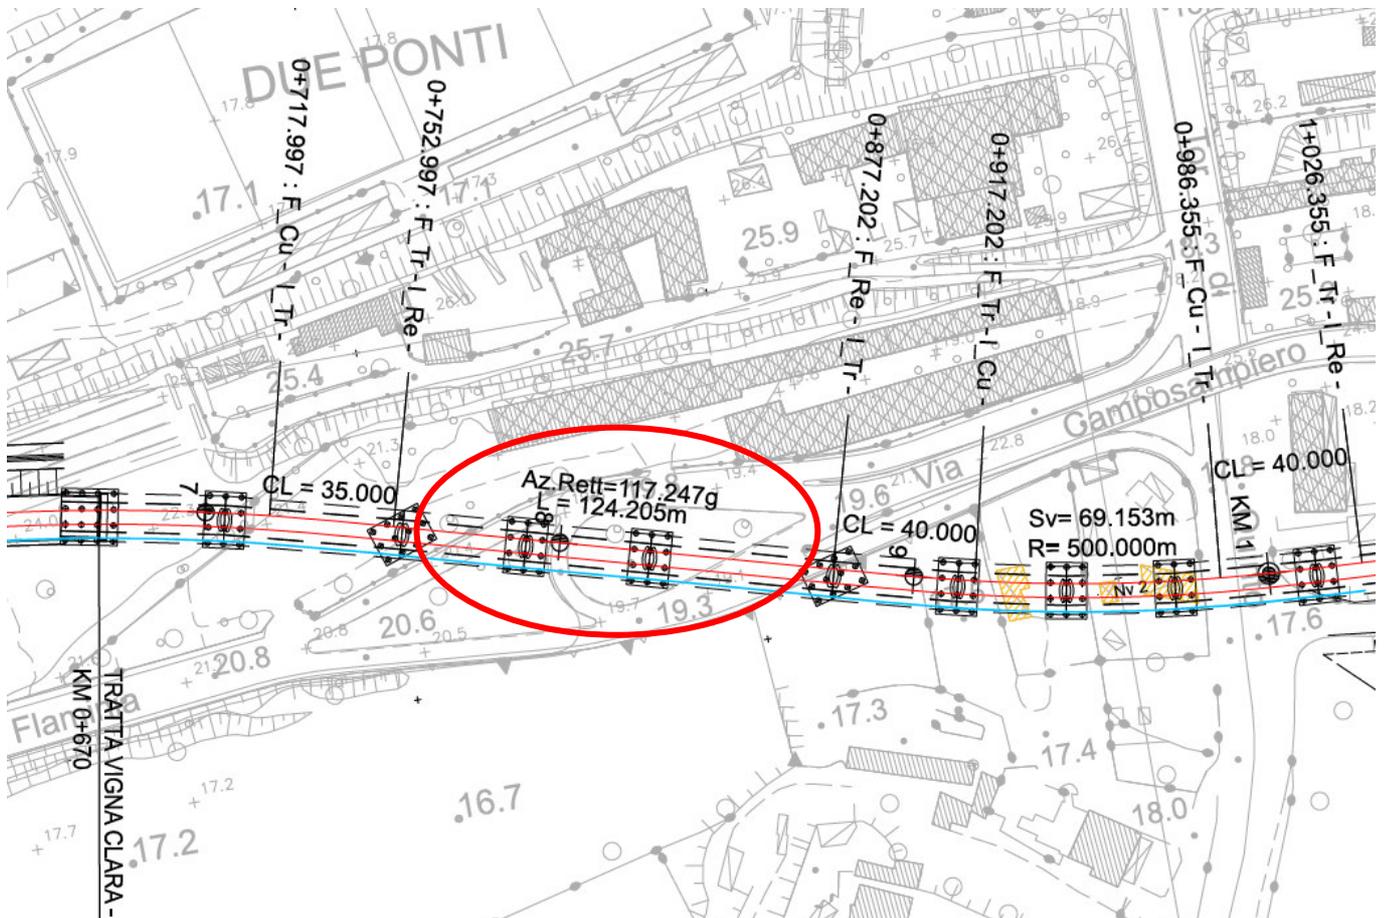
Stralcio planimetrico: intersezione con via Flaminia Vecchia
